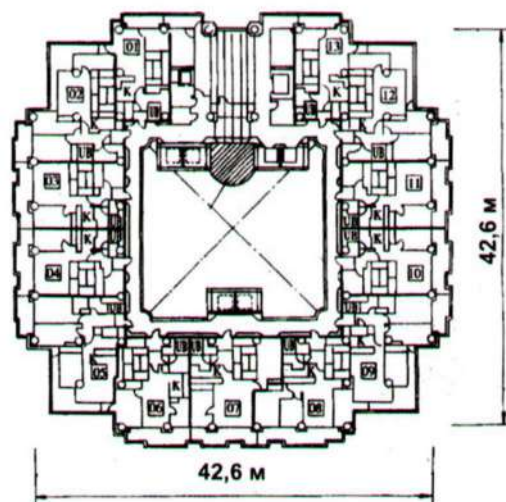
Жилой дом, г. Кавагучи, Япония. План этажа
